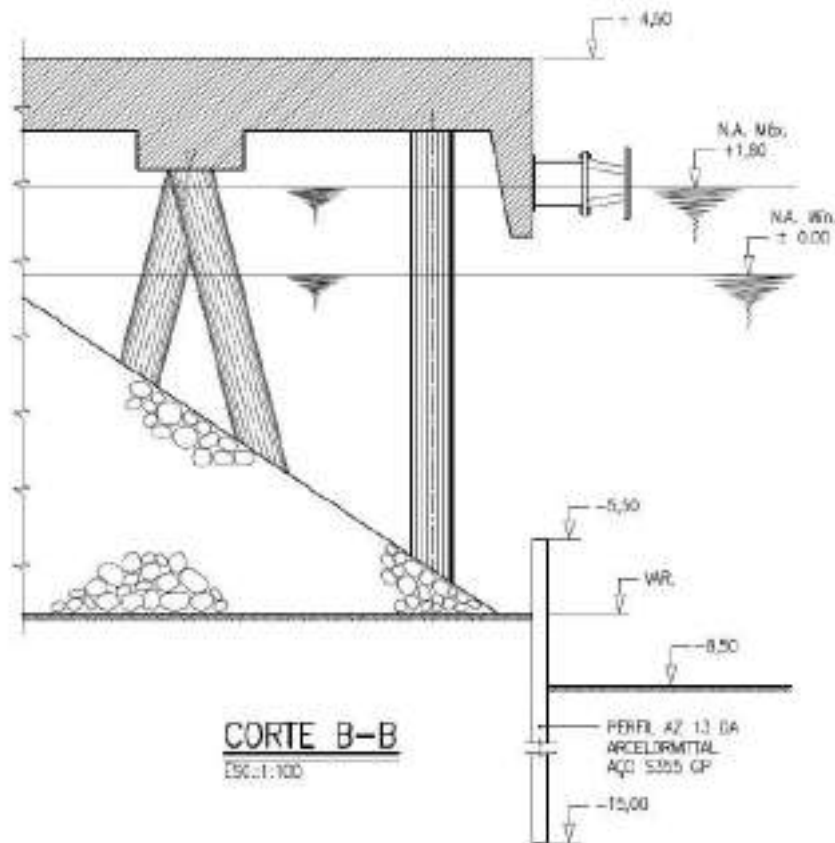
Exemplo esquemático de projeto de contenção para suportar cargas de enrocamento para dragagem de aprofundamento de berço.
